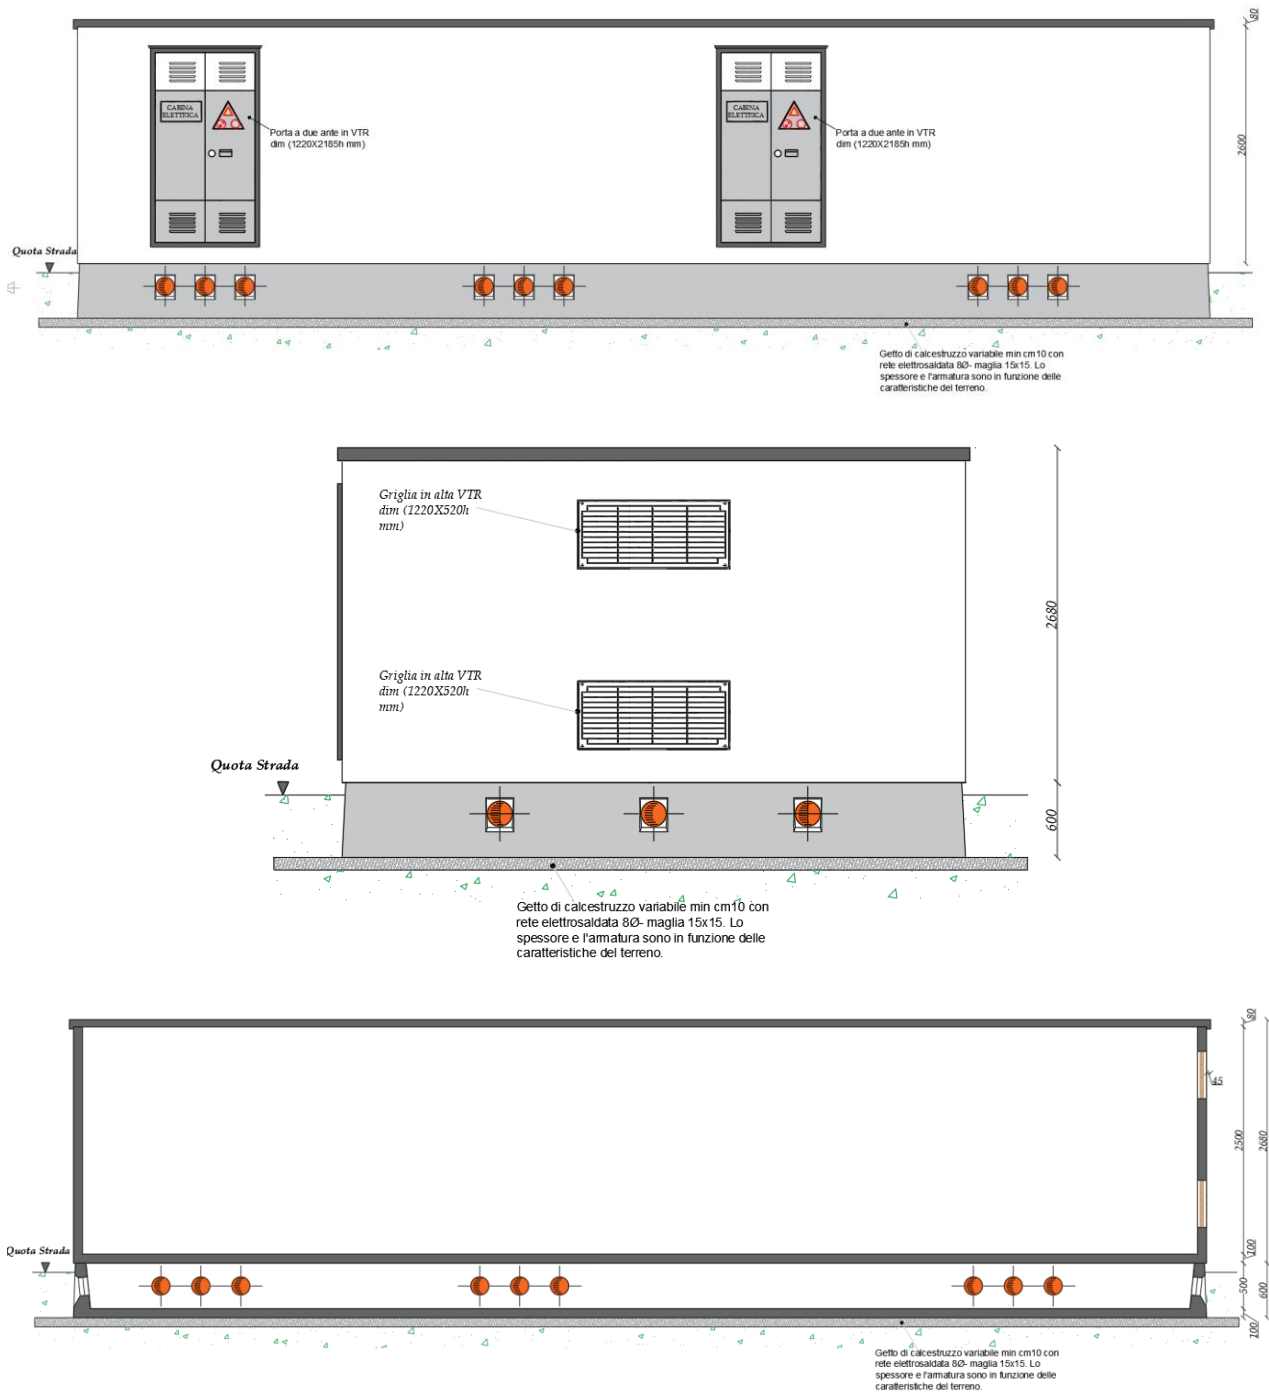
Cabina di raccolta a 36 kV: Pianta, prospetti e sezioni.
